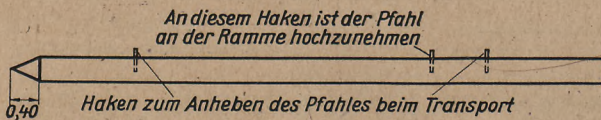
Stahlbetonrammpfahl mit Transporthaken
